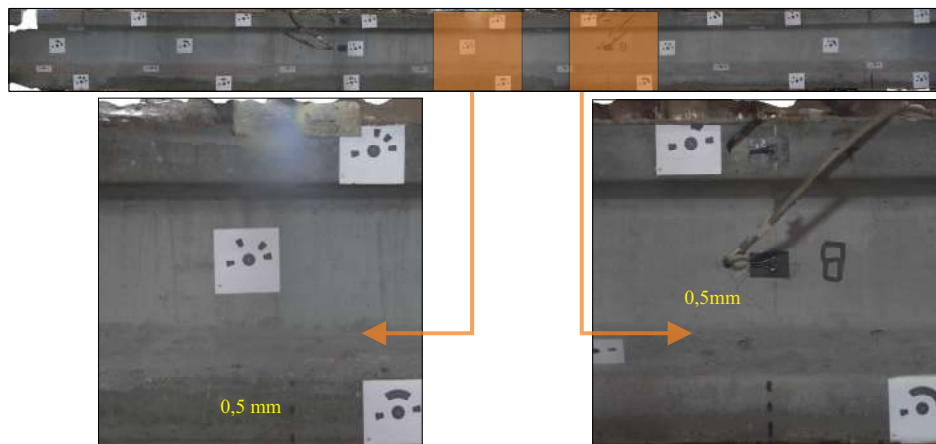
Fissuração máxima no 3<sup>o</sup> Ciclo - Viga UHPFRC (V03)
